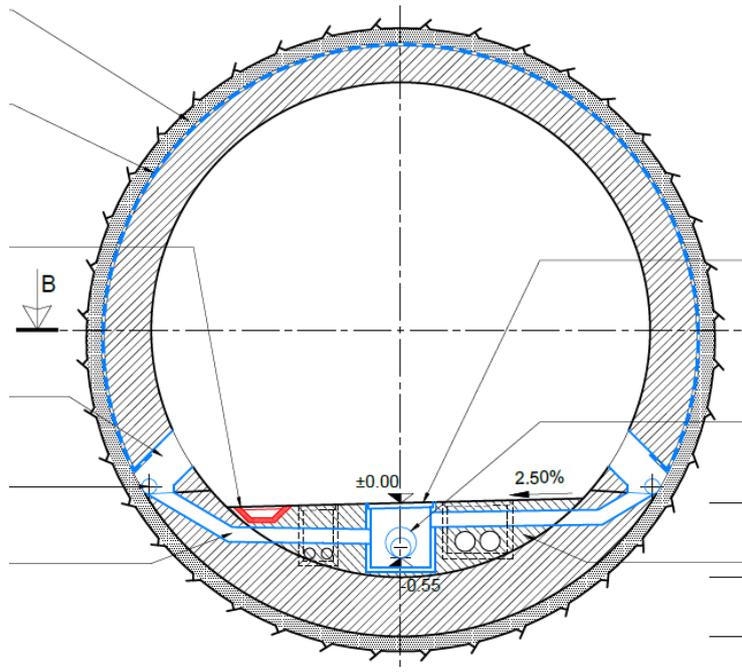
sistema di drenaggio della sezione corrente - galleria Maddalena 1
